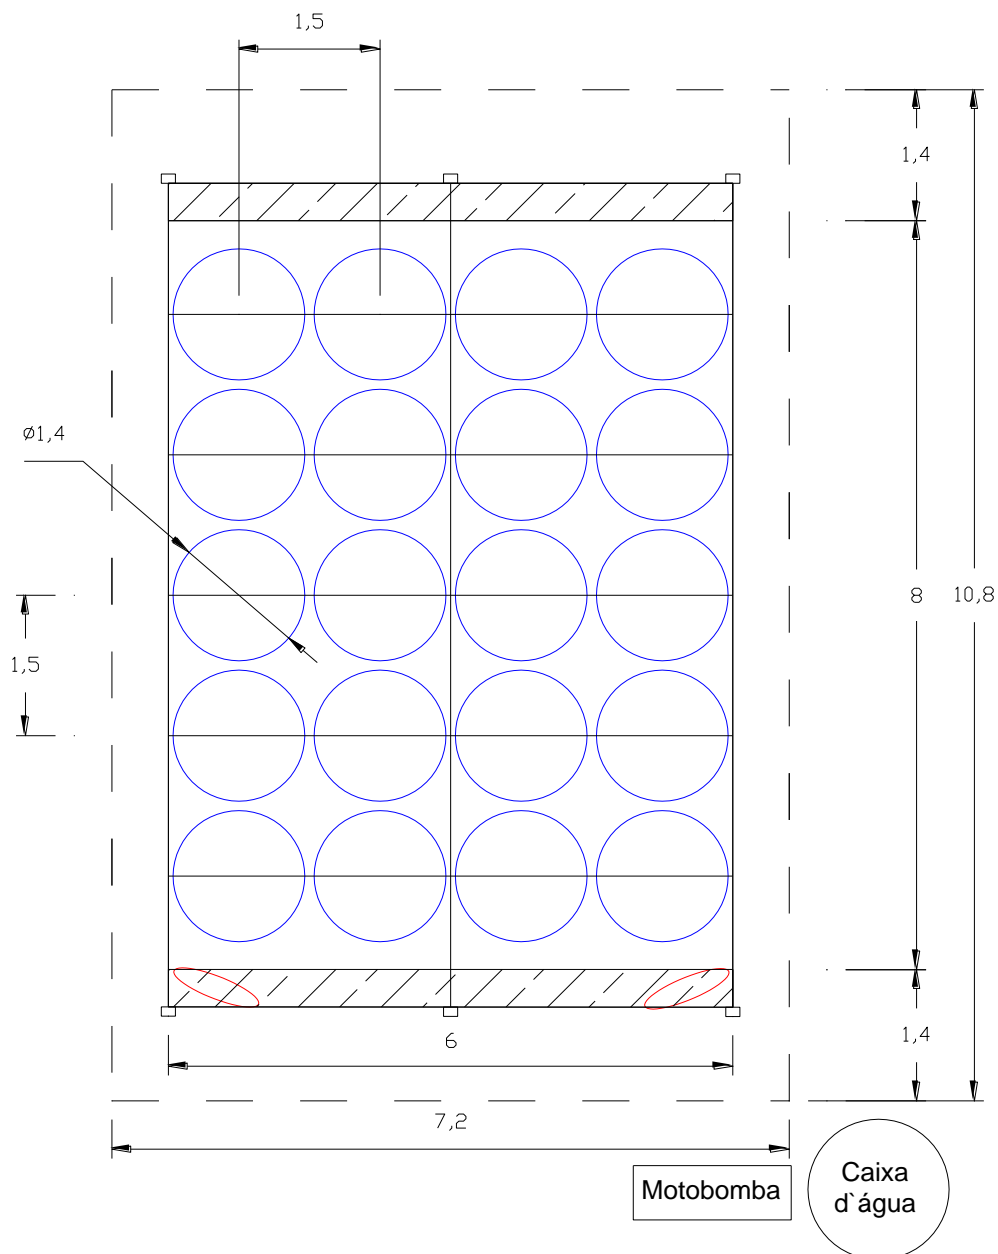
Planta baixa do curral de espera e localização dos ventiladores e das linhas de nebulização
